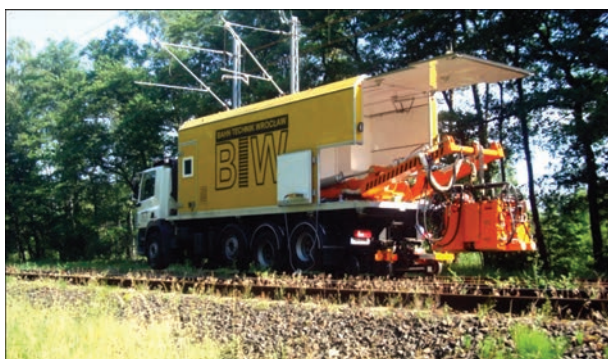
Мобильный рельсосварочный комплекс КСМ 007 со сварочной головкой K922-1 на базе автомобиля Вольво
